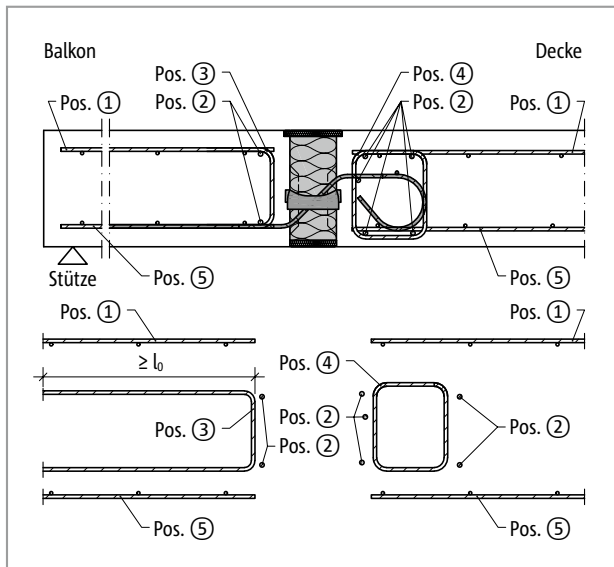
Schöck Isokorb® T Typ Q-V1 bis Q-V5: Bauseitige Bewehrung
